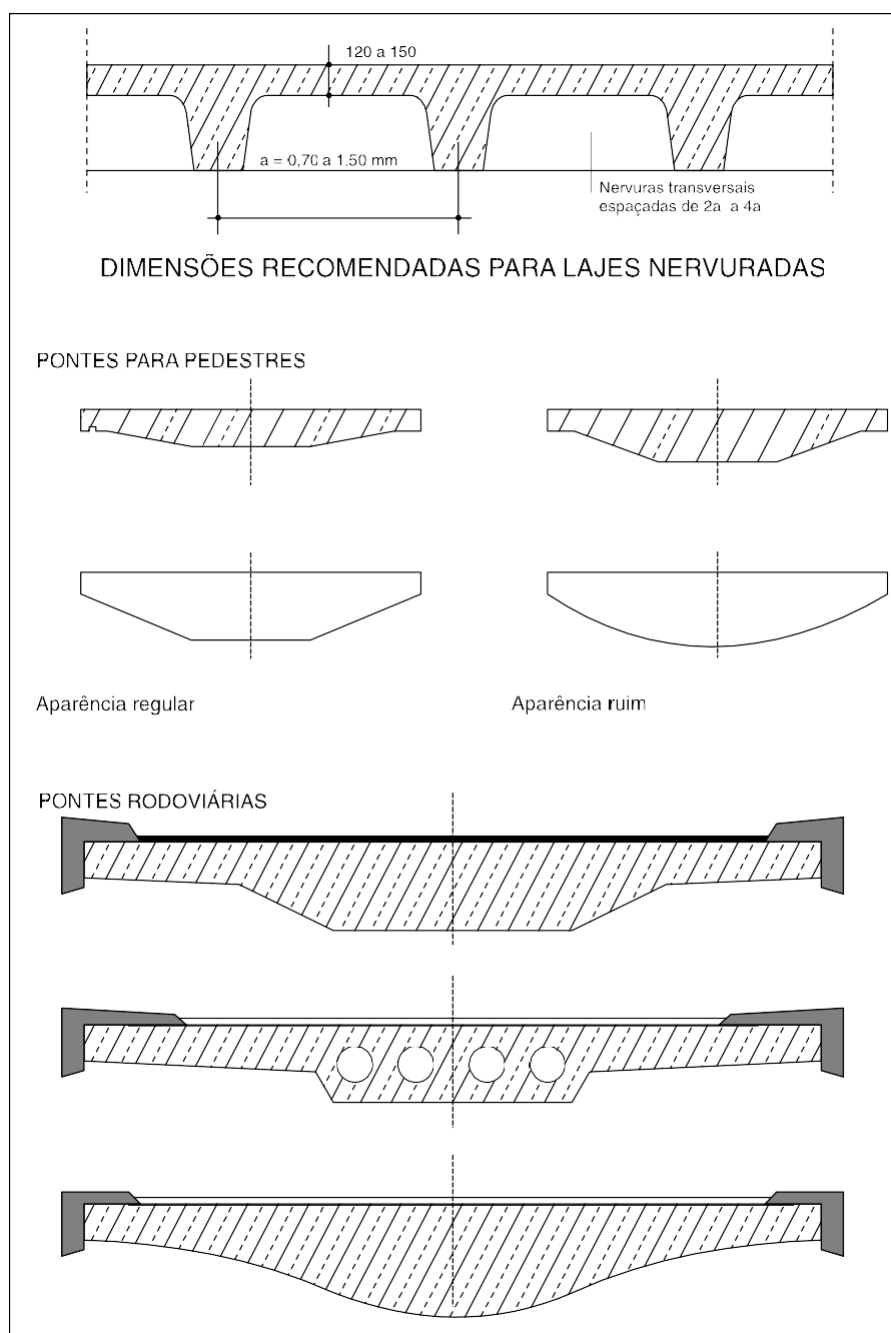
FORMAS POSSÍVEIS DE SE MELHORAR A APARÊNCIA DE PONTES EM LAJES ESBELTAS
